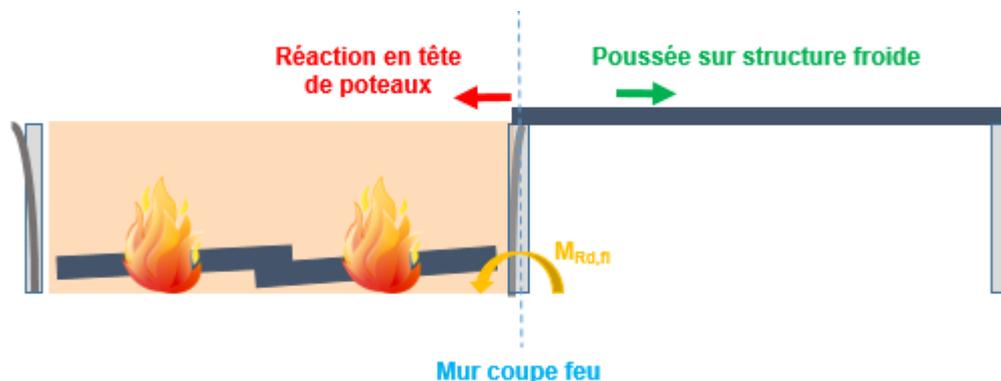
Effort en tête de poteau au droit du mur coupe-feu.
